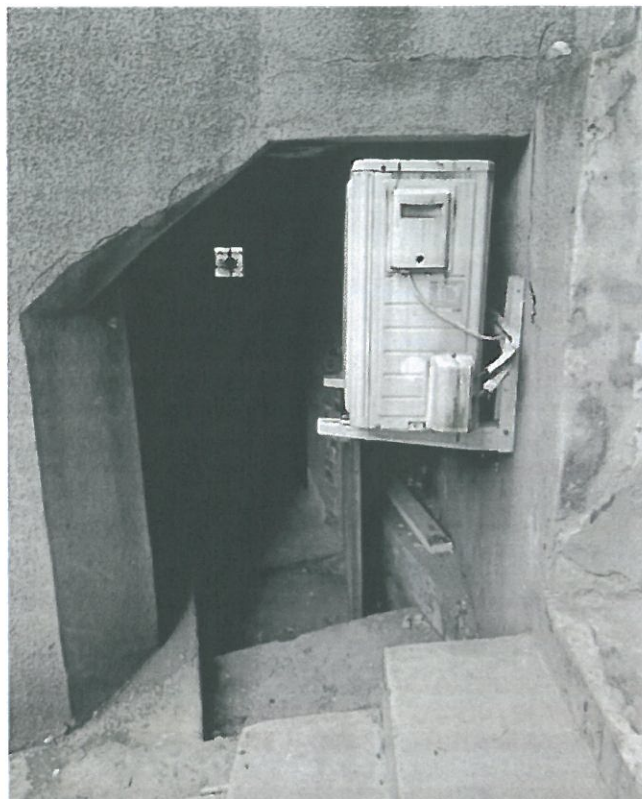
Elewacja podwórzowa budynku mieszkalnego
